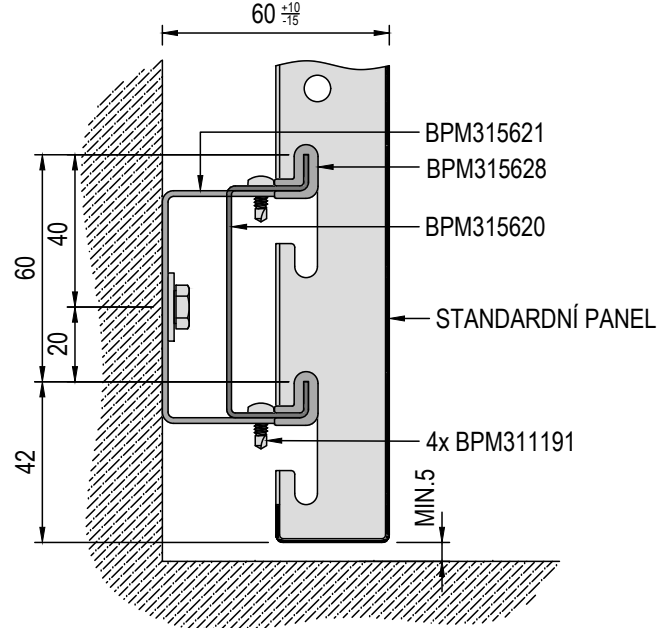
DETAIL ROHOVOU KRYCÍ LIŠTOU
